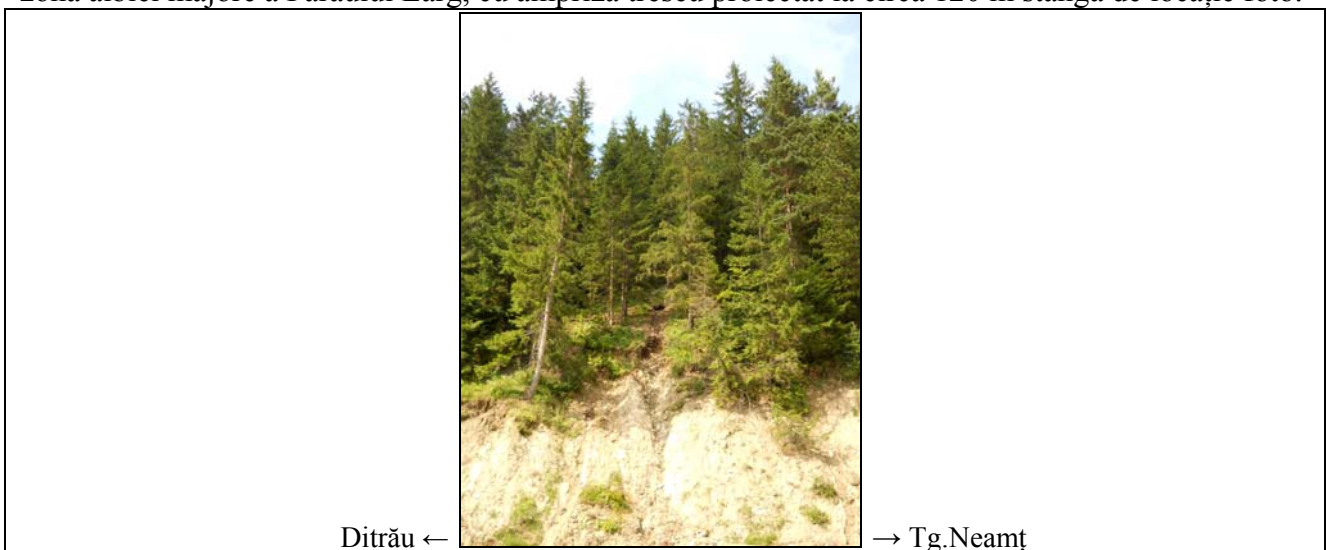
Detaliu traseu autostradă în zona km 58+150 ÷ 58+200 pe versant parțial împădurit, predominant acoperit cu pășune și vegetație hidrofilă; pantă generală versant - circa 45°, frecvent sunt prezente pe versant vâluriri și ravenări; Detaliu foto din zona albiei majore – malul stâng al Pârâului Larg, cu ampriză traseu proiectat la circa 150 m stânga de locație foto.
